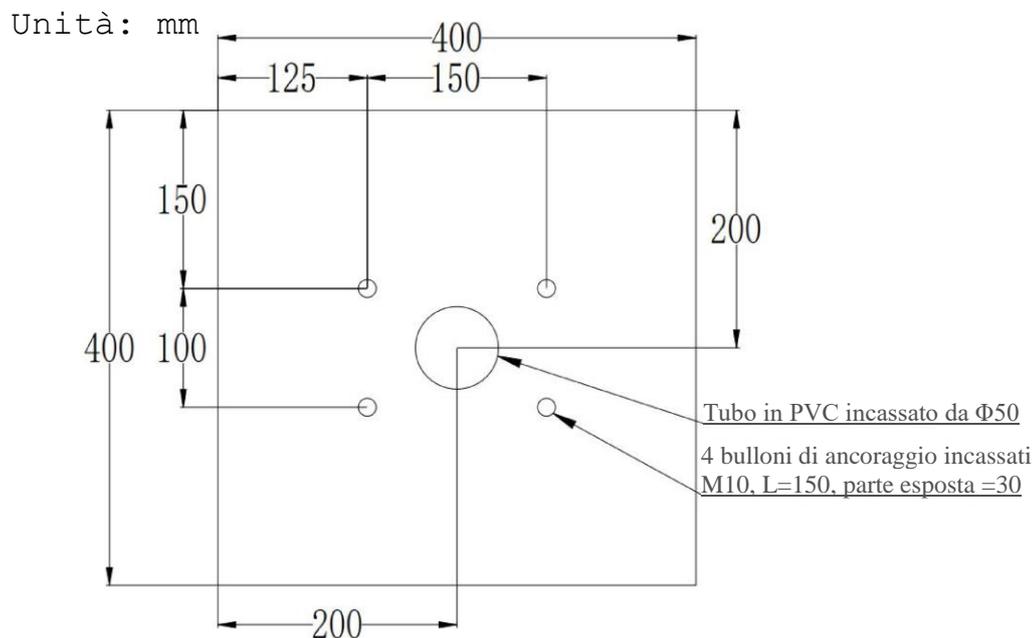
Disegno dall'alto della fondazione in calcestruzzo
